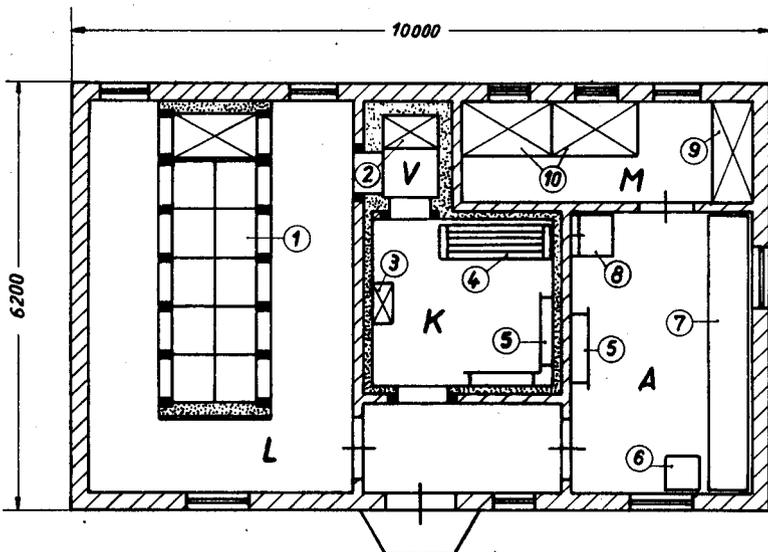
Grundriß einer vollständig eingerichteten Schrankanlage.
